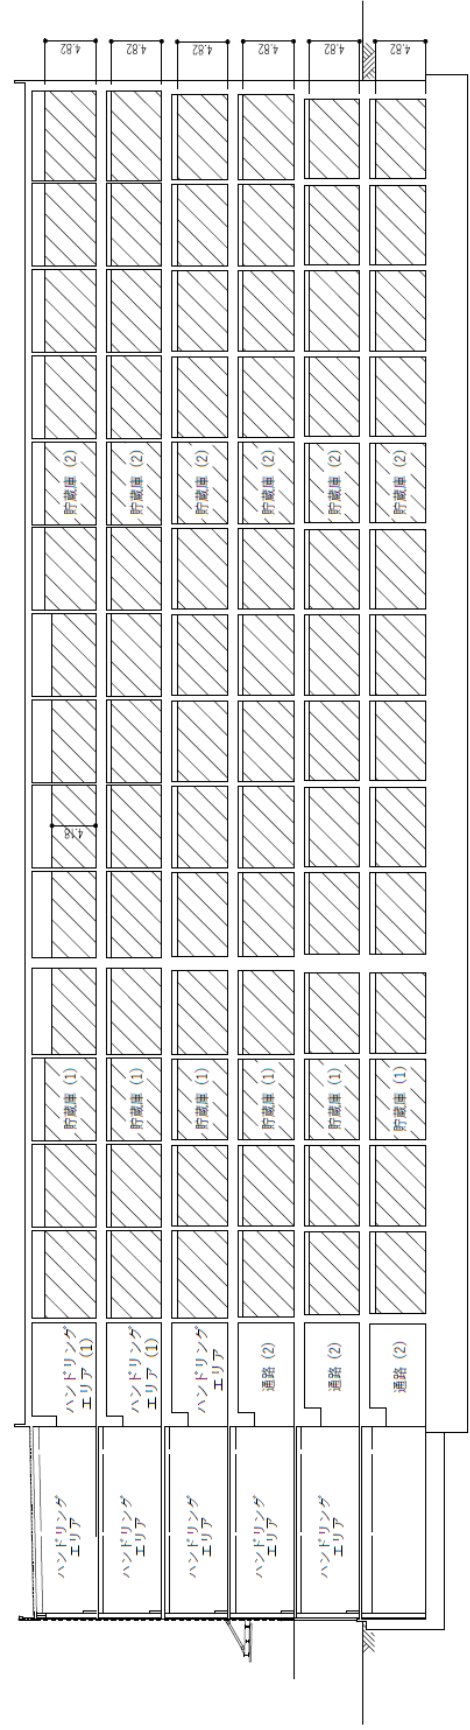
1 固体廃棄物貯蔵庫第1棟 5階 平面図 (単位: m)
